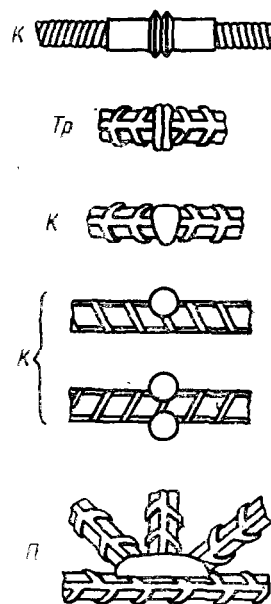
Виды сварных соединений арматуры при разных технологических процессах сварки: *к* — контактная; *тр* — трением; *п* — плавлением
